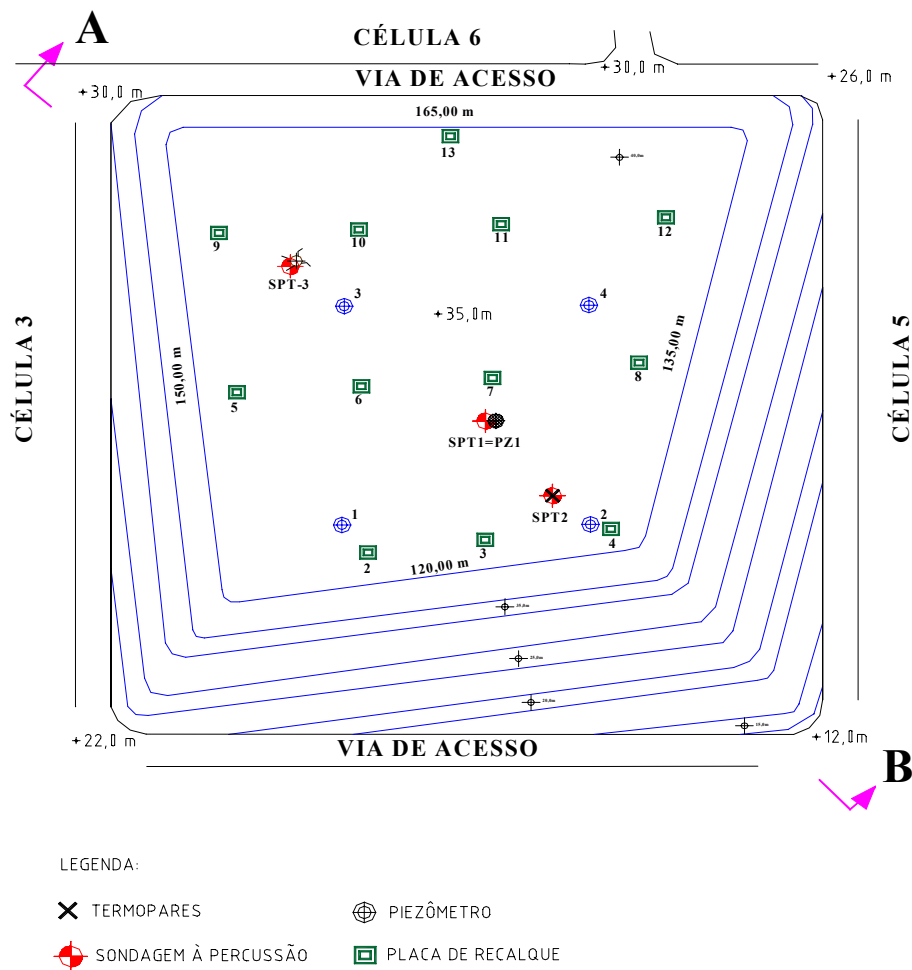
Planta da Célula 4 mostrando a instrumentação instalada
